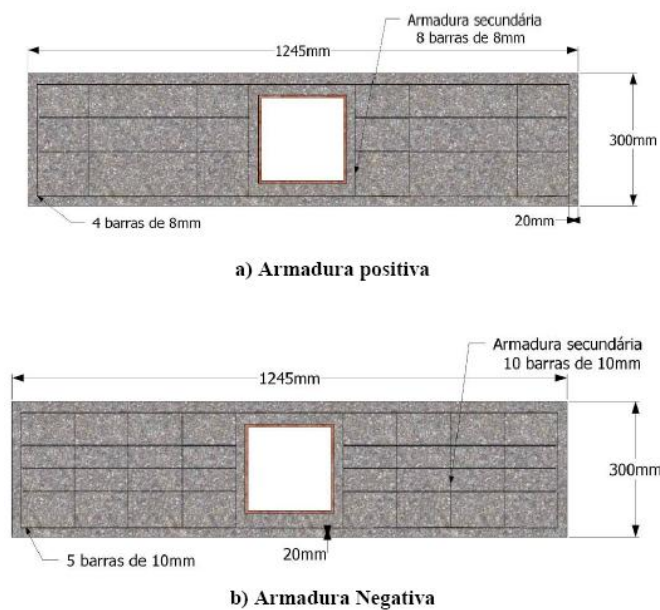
Detalhes da laje de concreto armado. Farias (2008)
